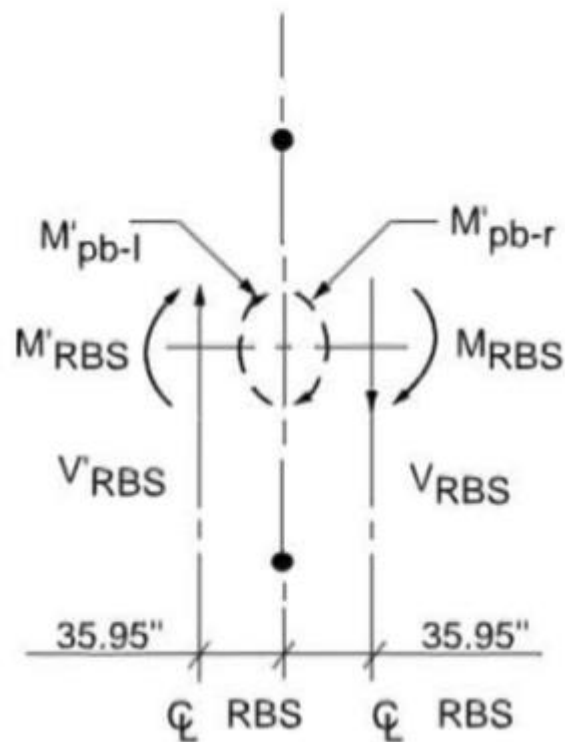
Diagrama de cuerpo libre para sección viga - columna
